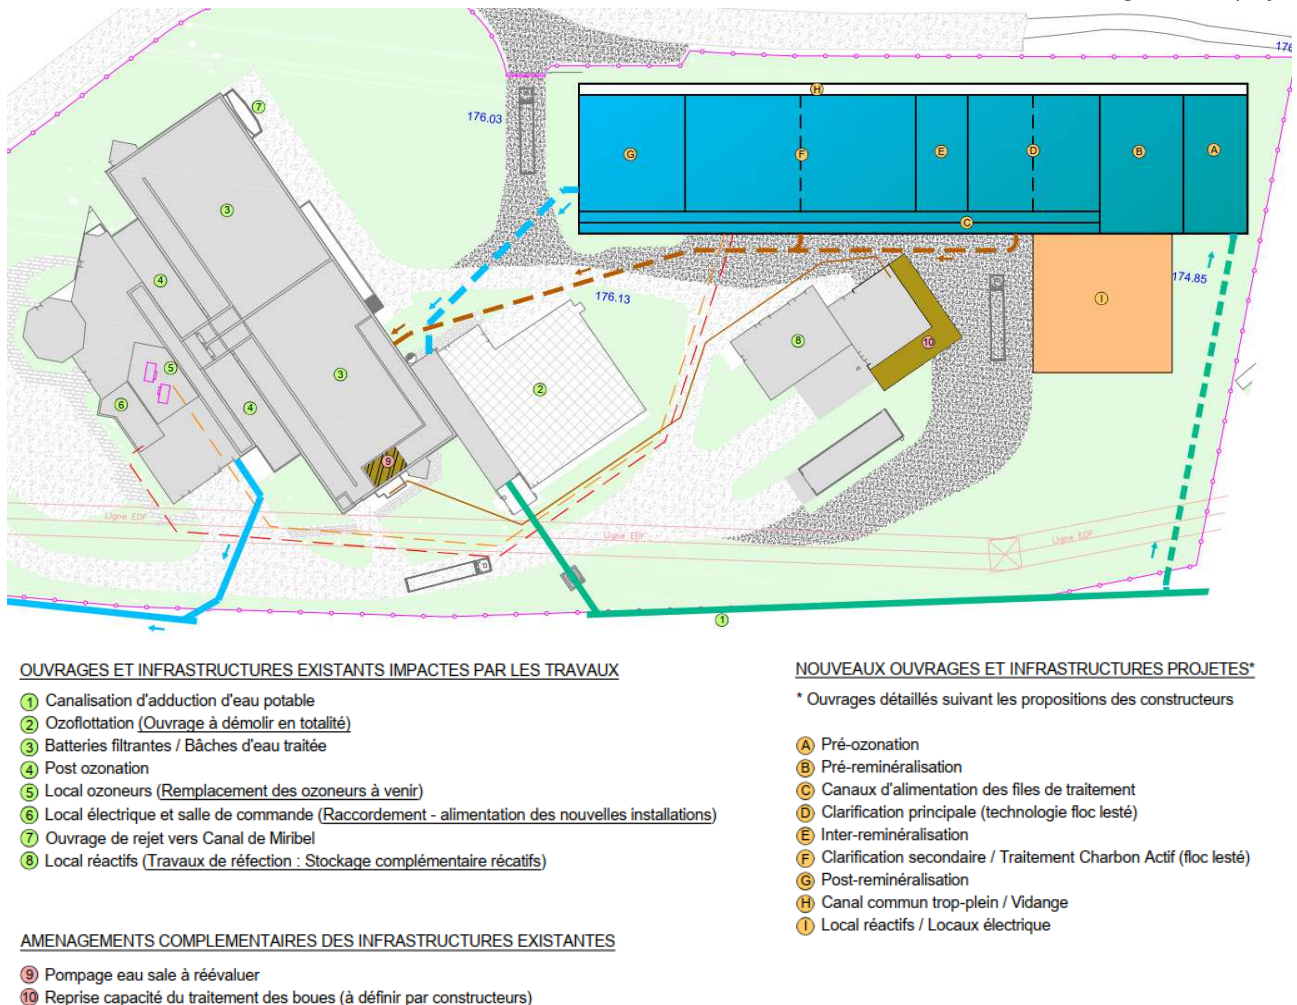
plan masse – implantation des ouvrages (issue des études de faisabilité)
